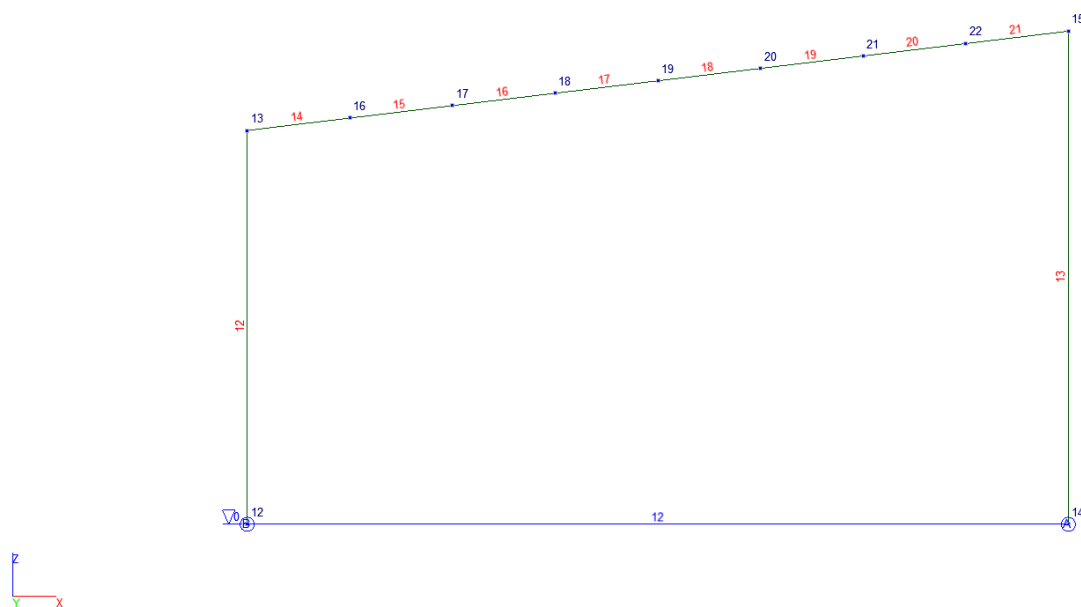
Расчётная схема поперечной рамы здания в осях 4/А-В (каркас)
